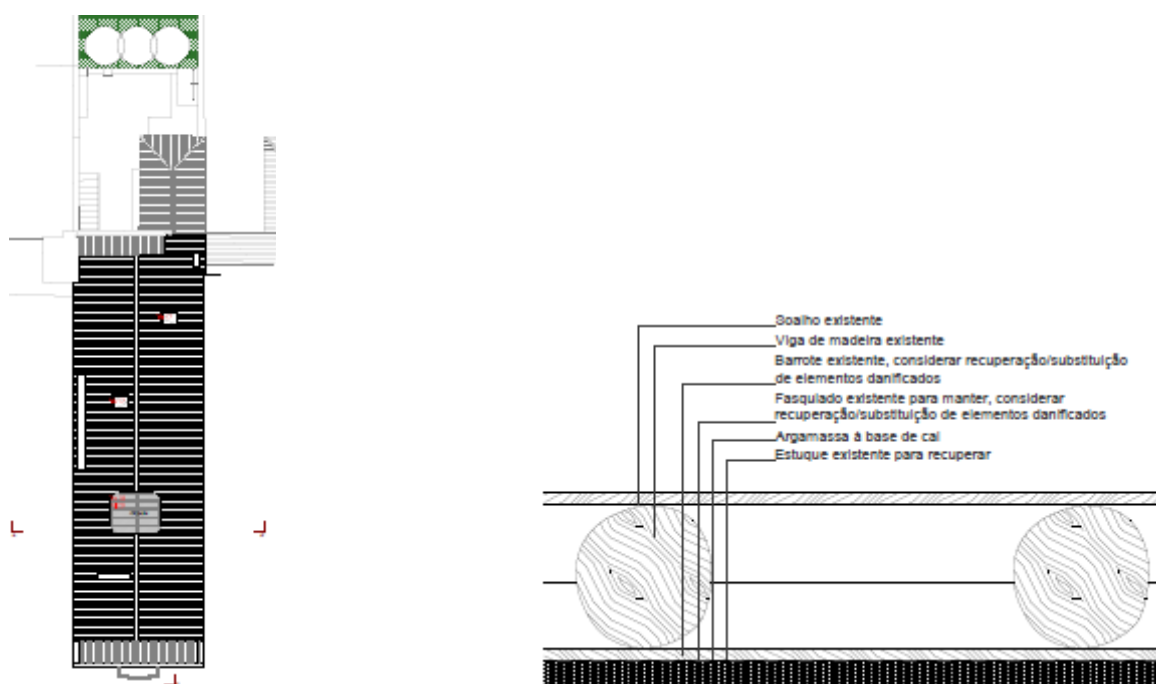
Planta de Cobertura (Floret, 2018) Figura 7 – Pormenor Pavimento Existente (Floret, 2018)
